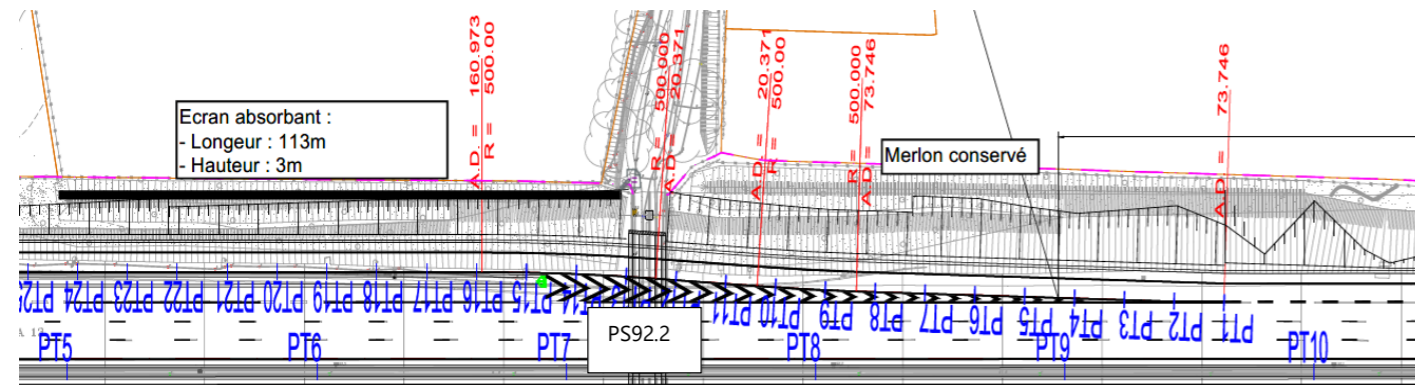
PLAN D'IMPLANTATION DE L'ÉCRAN ACOUSTIQUE
